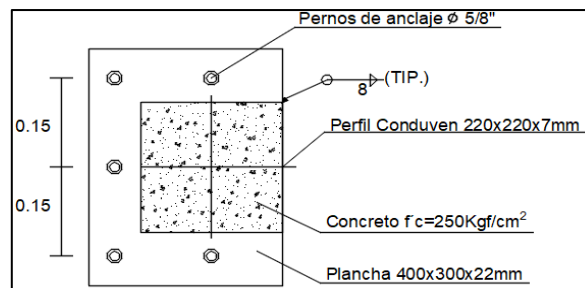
Detallado de sección de columna mixta rellena de concreto $f'c=250\text{Kgf/cm}^2$.
